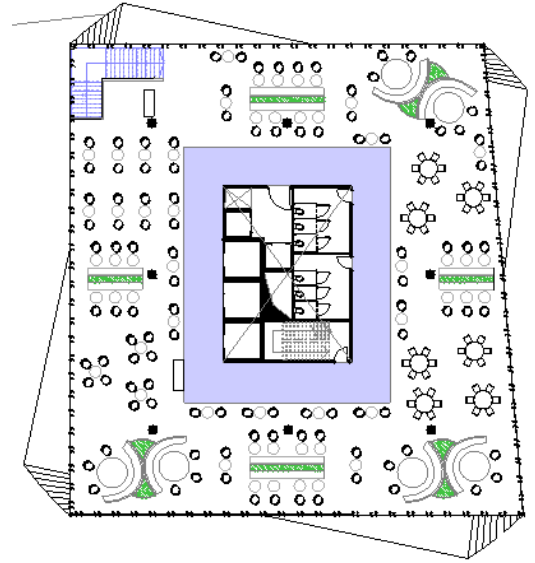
Plan de restaurant d'hôtel (auteur2019)
